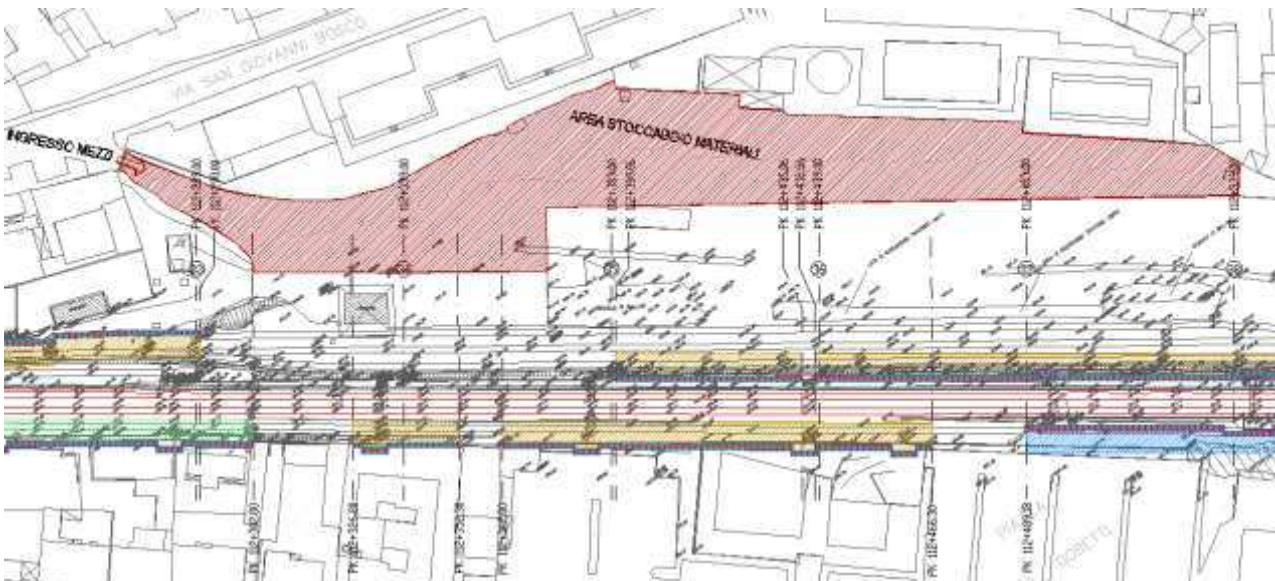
Stralcio planimetrico Area Cantiere Stoccaggio materiali
